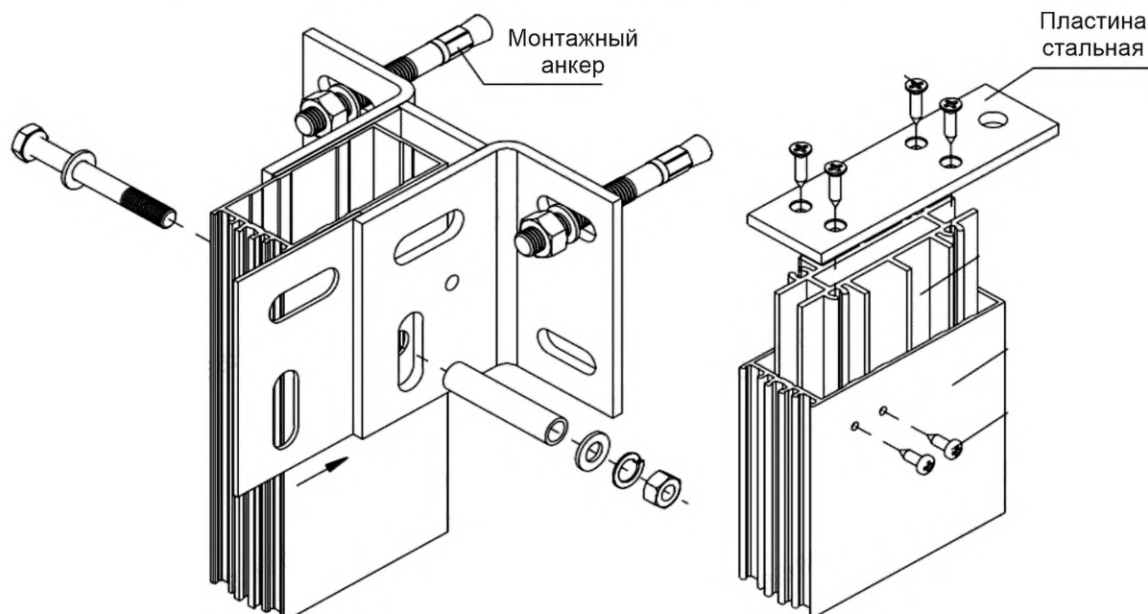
Монтаж рам и стоек навесных СПК в торец плиты перекрытия
